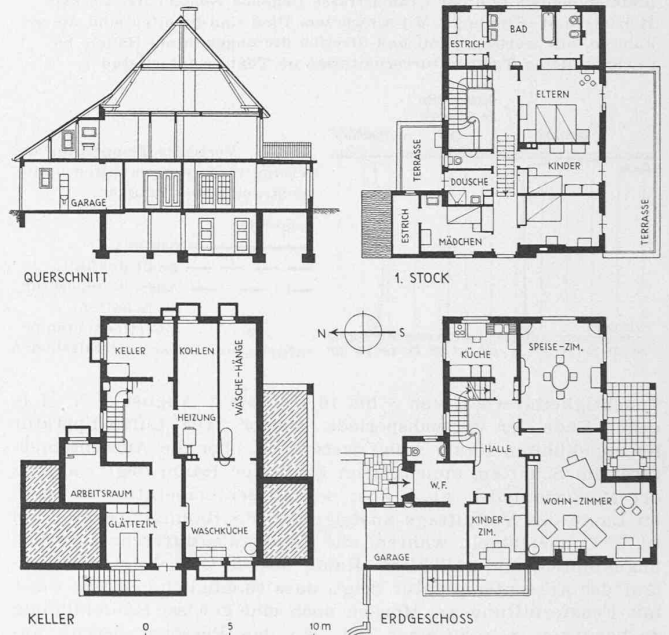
Landhaus Dardel. Grundrisse und Schnitt 1 : 400
